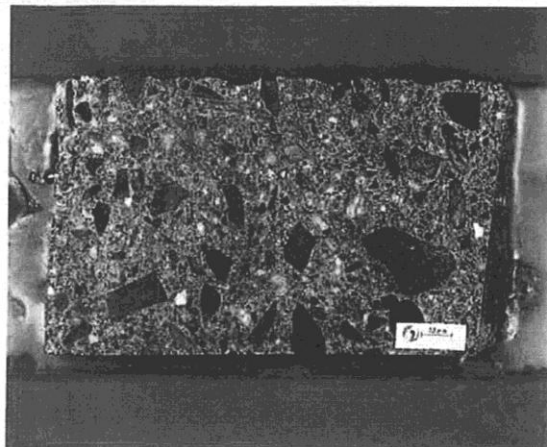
Bildet viser planslipet av kjerne B1. Overflaten er til venstre i bildet
